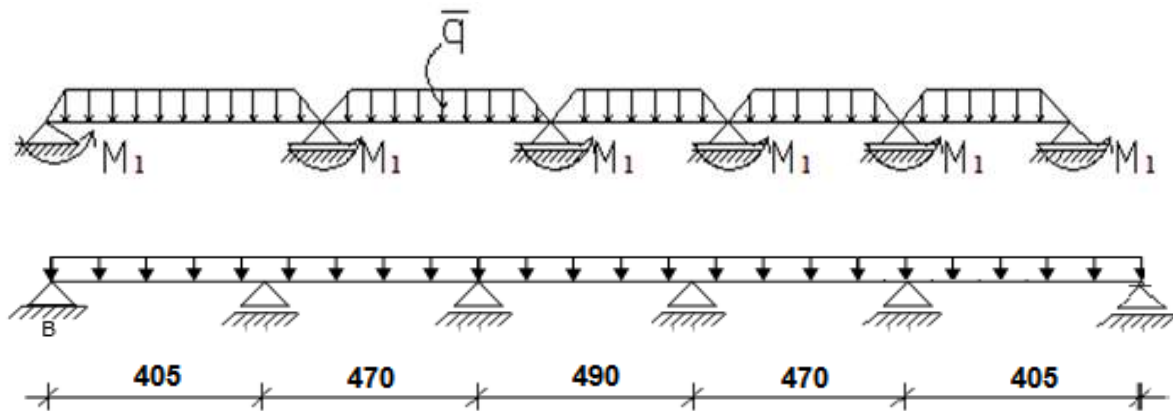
Distribution des charges sur les poutres secondaires
